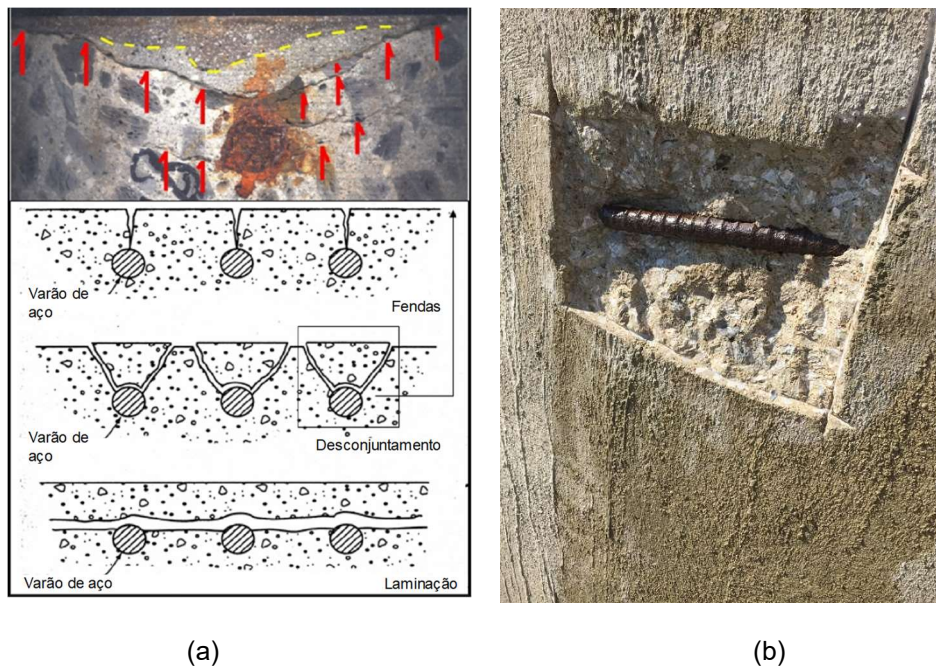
(a) - Fotografia de um desconjuntamento de betão. (b) – Representação esquemática de um desconjuntamento de betão (Adaptado de (Jana, 2016)).
